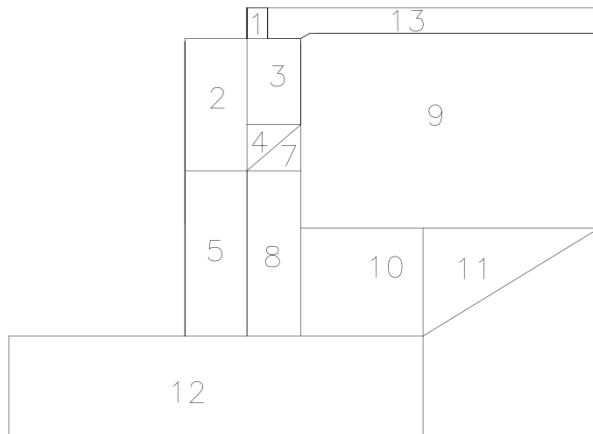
Pembebanan Abutment akibat beban mati bangunan atas
